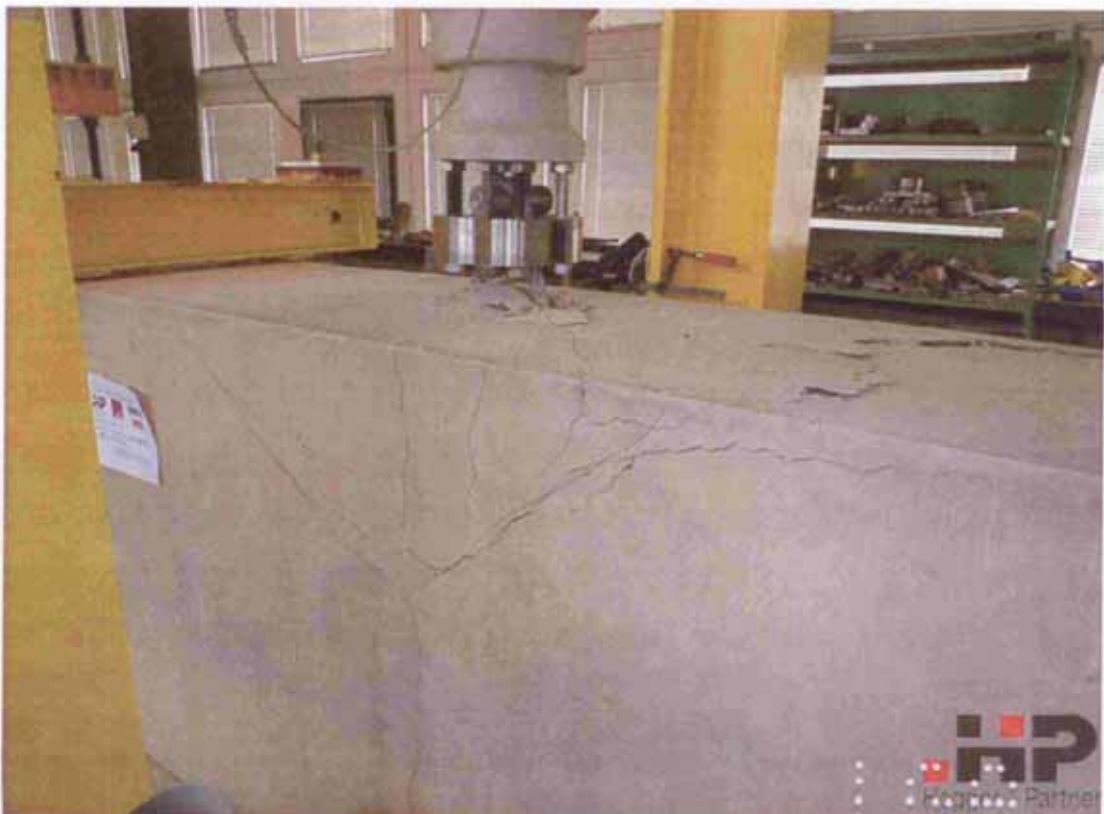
Fortgeschrittene Rissbildung und beginnender Betonausbruch
